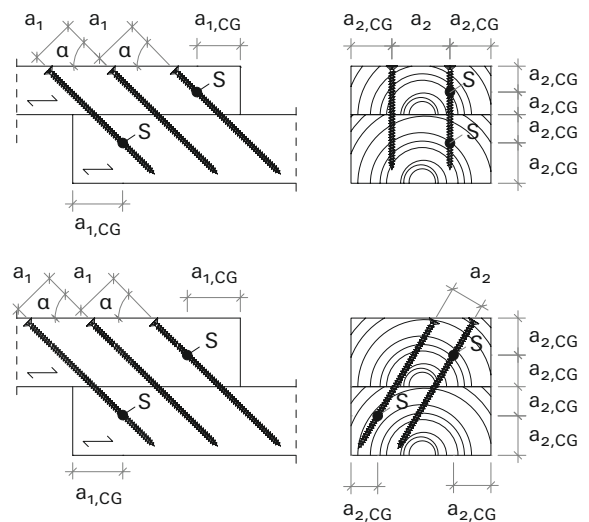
Definition der Mindestabstände für axial belastete Schrauben
